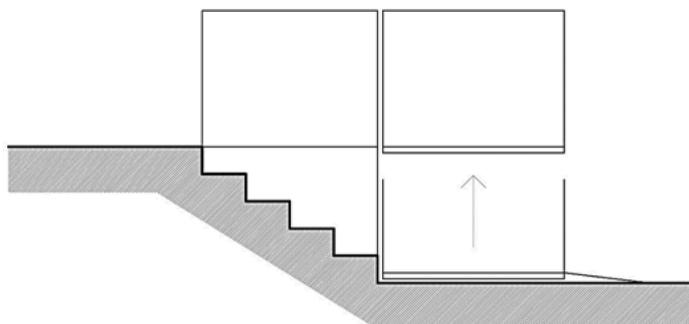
8. Instalación de plataforma elevadora vertical superpuesta a la escalera existente
